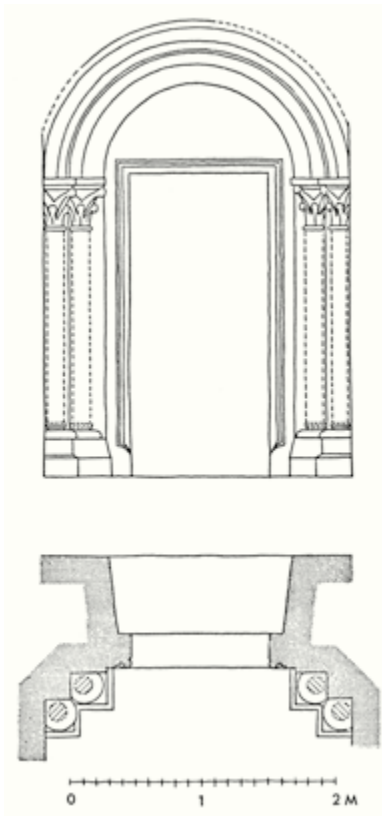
a und b: Stiftskirche in Ardagger. Grundriss in Schnittebene des Hochchors und Plan-darstellung des Südportals
